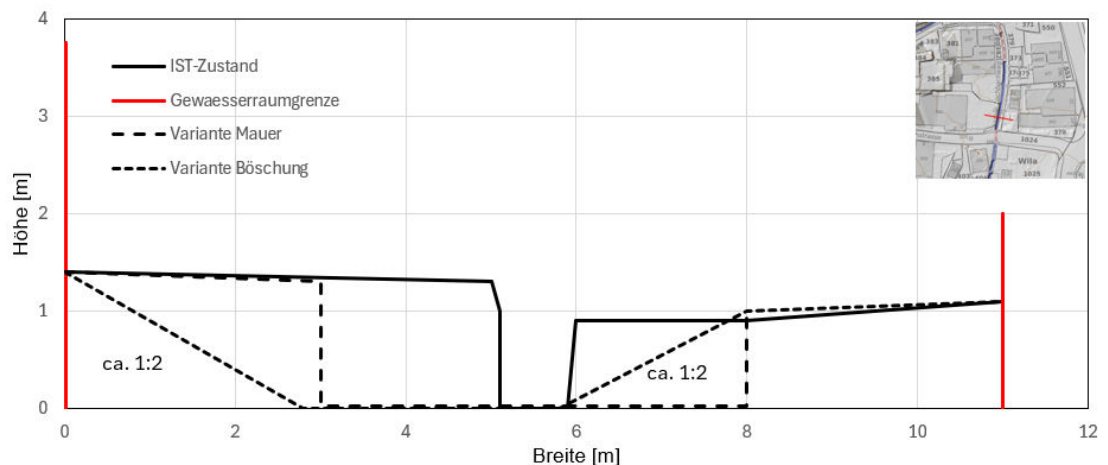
Querprofil darstellung IST-Zustand Lochbach (Loc-03) und mögliche Ausgestaltung des minimalen Gewässerraums mit Mauern oder Böschungen mit Neigung 1:2.
